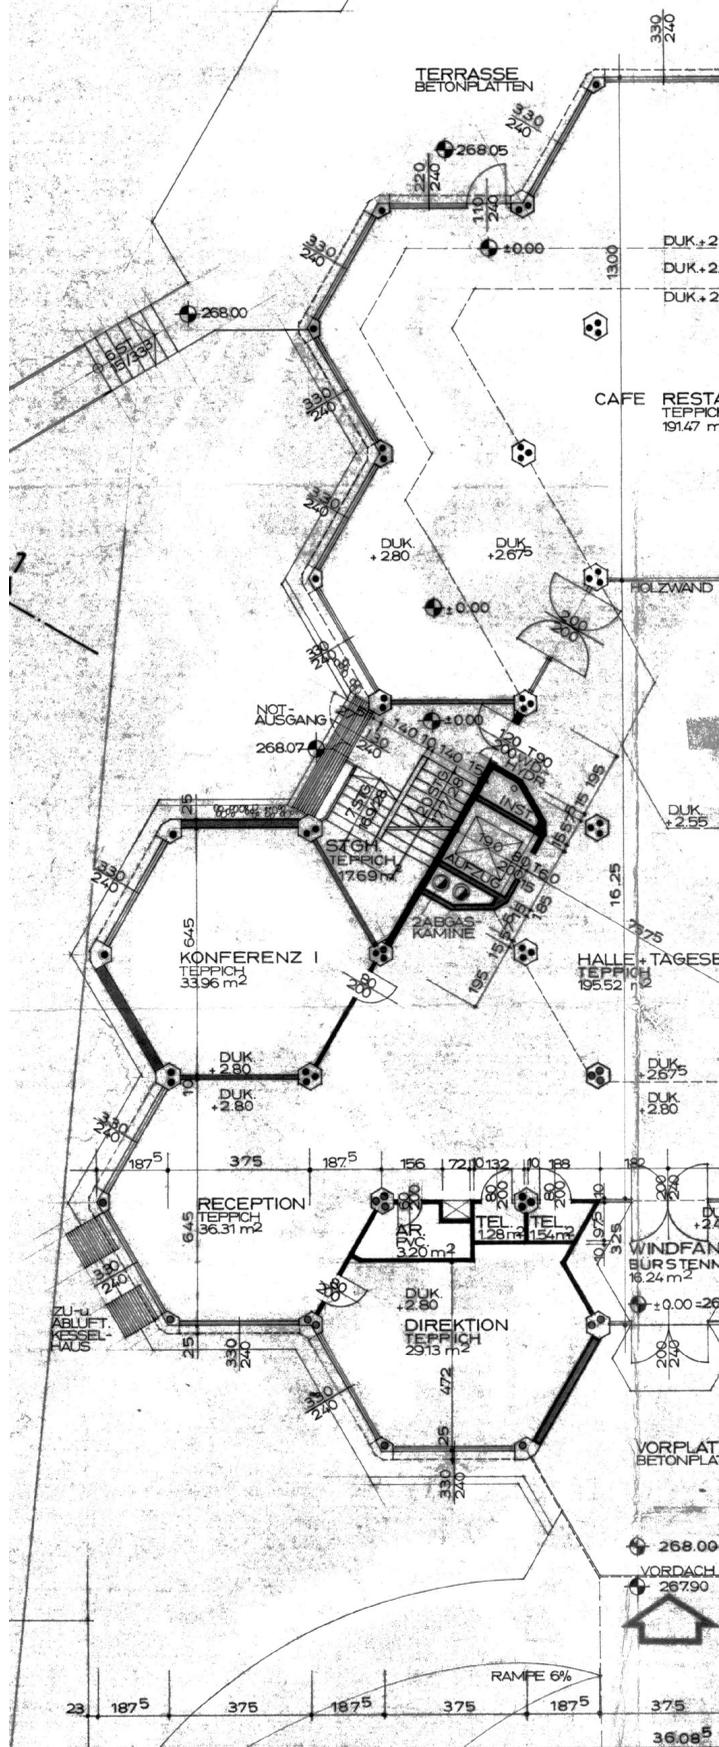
Grundriss Erdgeschoß MST 1:200
